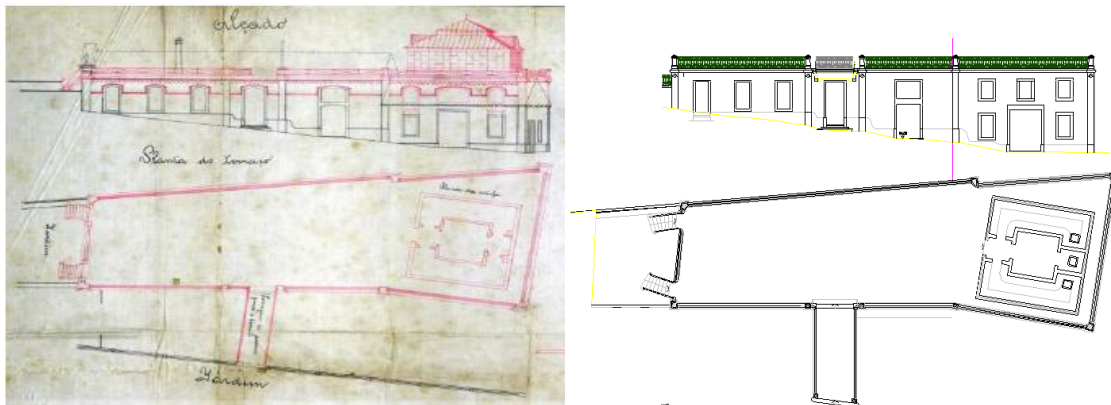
Alçado e Planta do Terraço de 1912 e Alçado planificado e planta de 2001.
